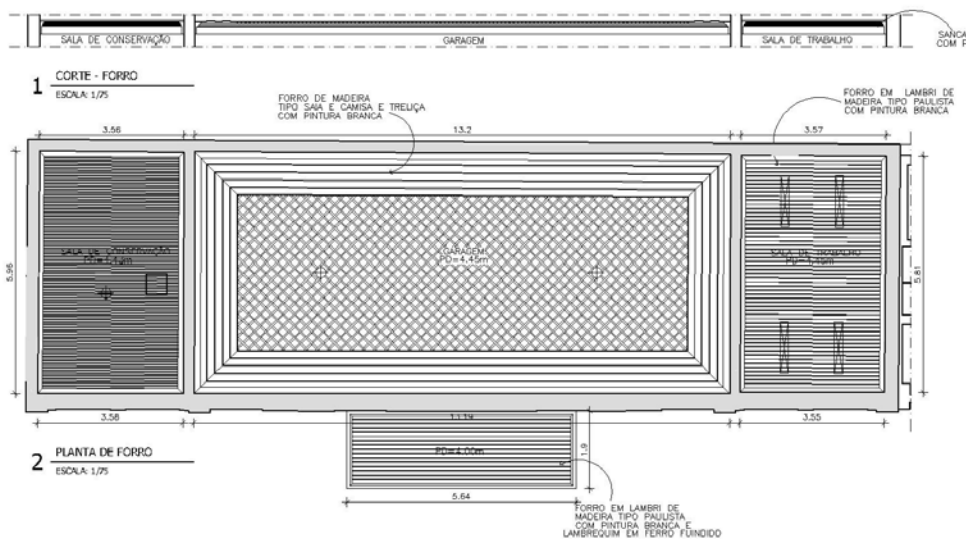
Exemplo de planta de forro. Projeto de restauração de telhado da Garagem da Casa de Rui Barbosa, Botafogo, Rio de Janeiro, RJ. Fonte: Arquivo Bk Arquitetos Ltda.
